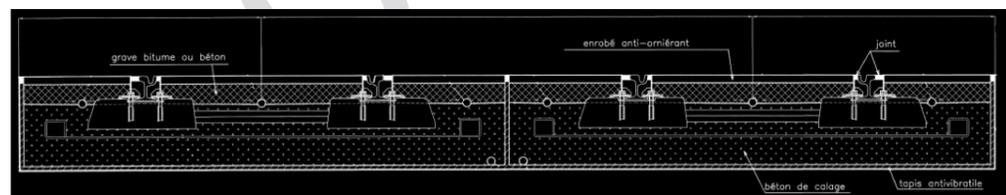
Représentation schématique d'une pose de voie sur dalle flottante.
